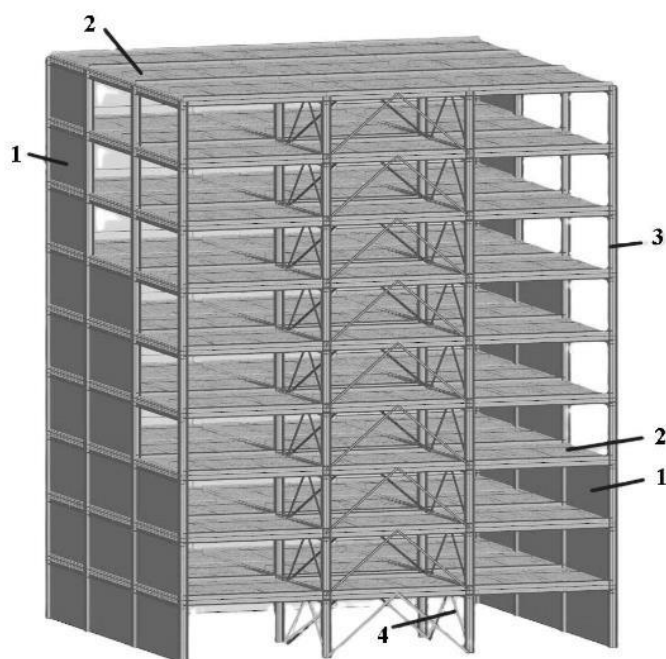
Пример комбинированного каркаса из металлических конструкций, с ядром жесткости, со стеновыми дисками и перекрытиями из деревянных панелей: 1 – сборные деревянные панели; 2 – деревянные панели перекрытия; 3 – стальной каркас; 4 – металлические элементы связей, объединенные в ядро жесткости
